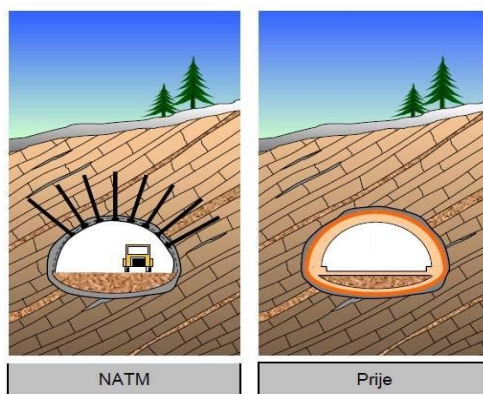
Primjena mlaznog betona umjesto drvene podgrade (Ilijaš, 2018.)
